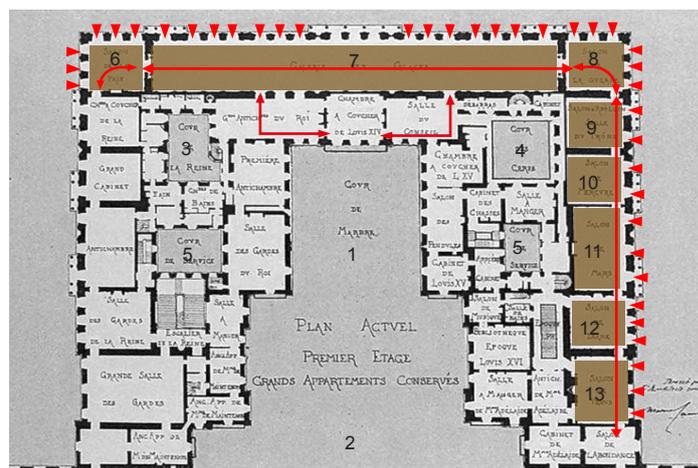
Figura B. Plano de planta del palacio de Versailles (siglo XVIII). Francia
